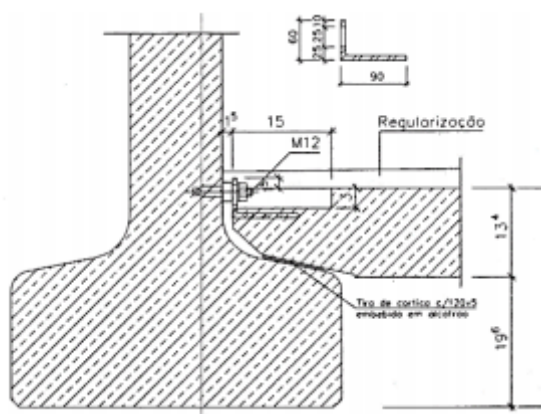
8: Esquema da secção transversal com pormenor das ligações laje-viga (S.A., 2000)
